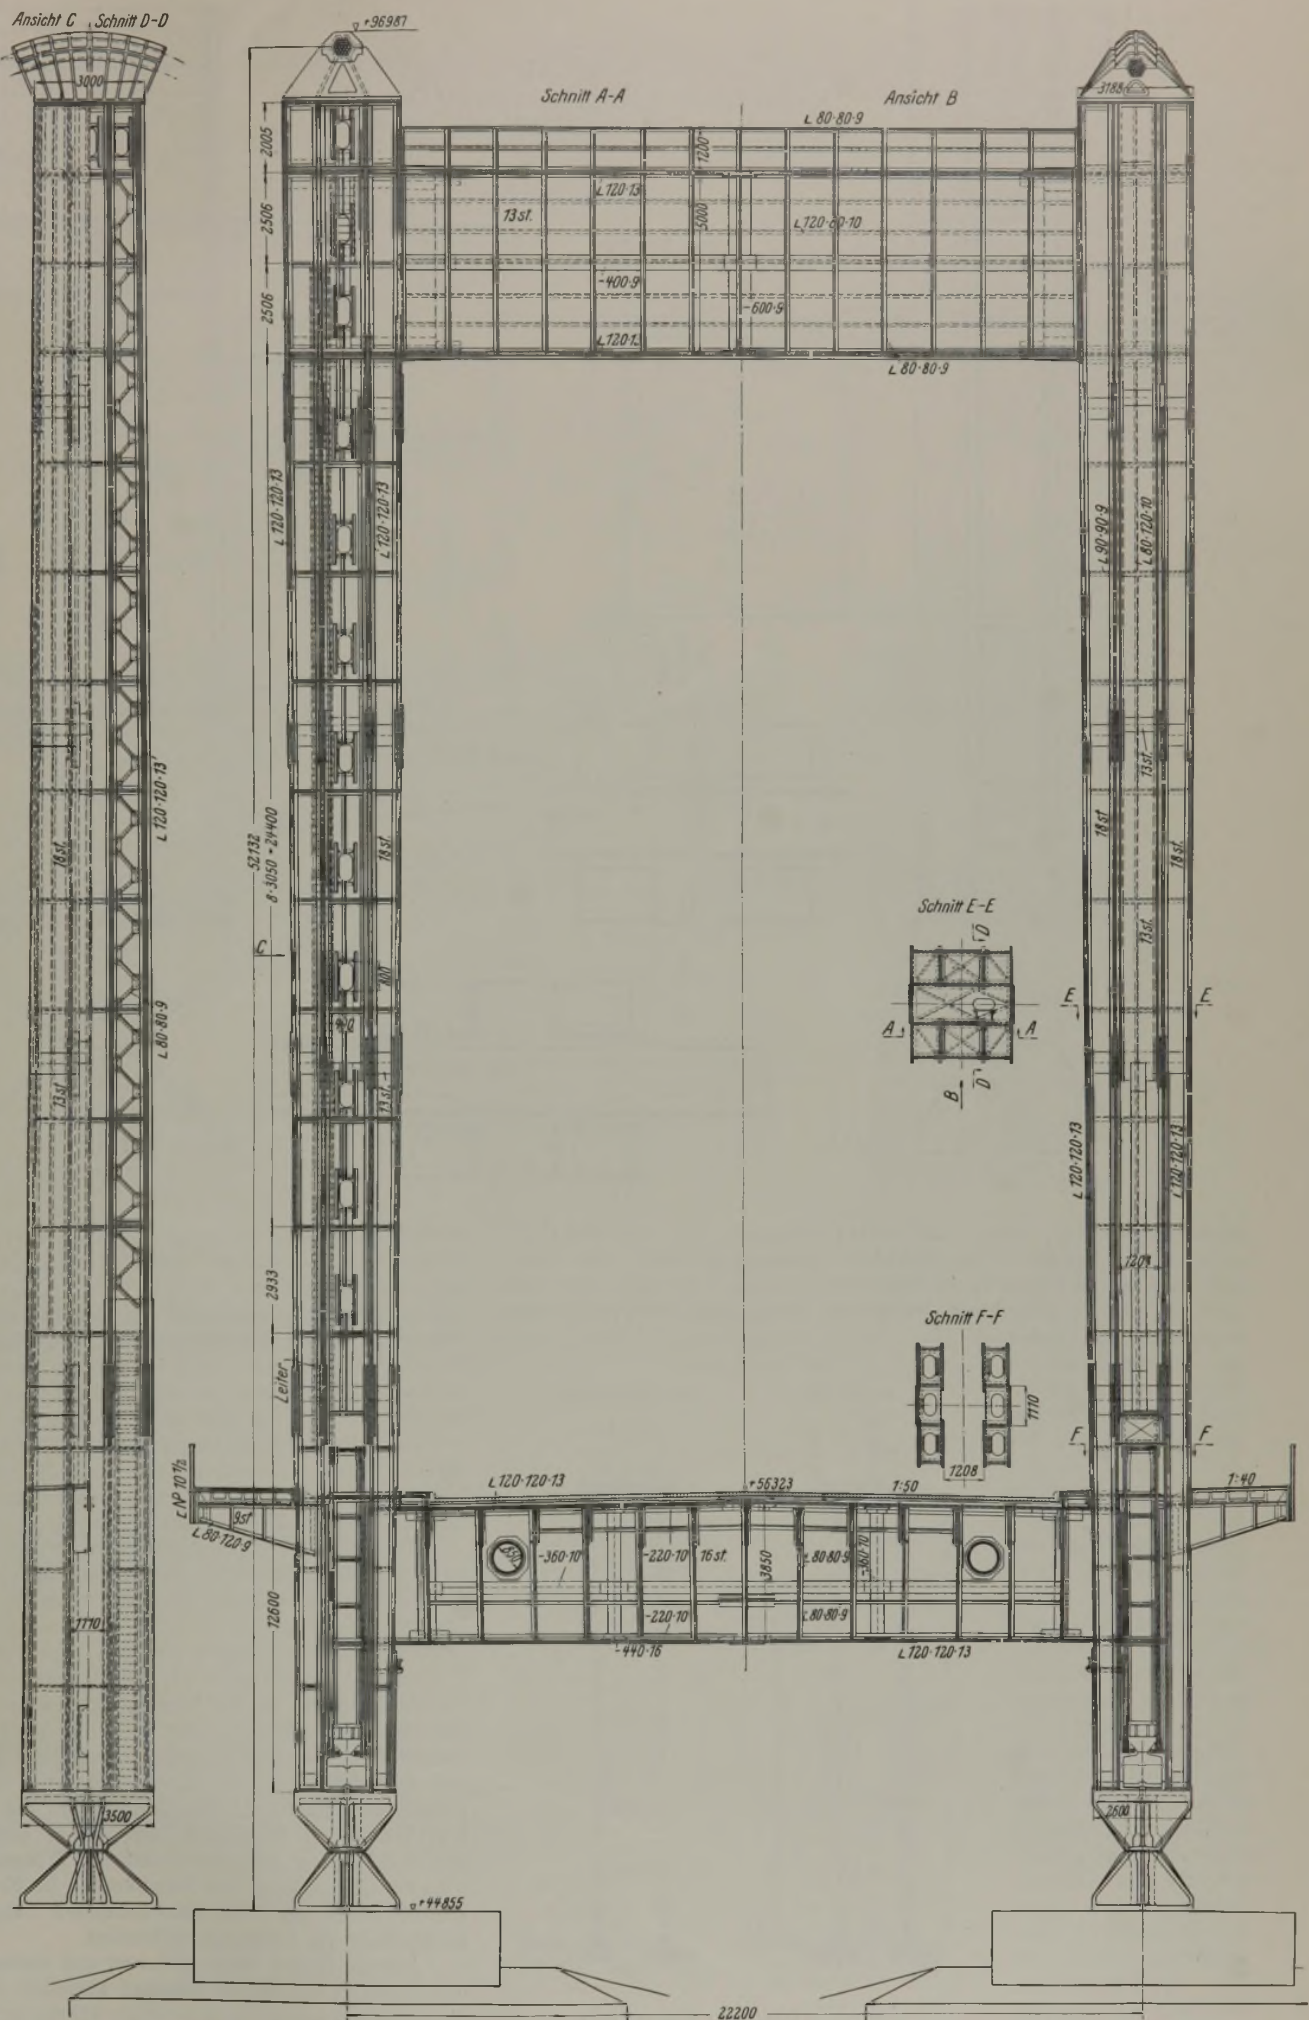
Brückenquerschnitt am Pylonenpfeiler.
